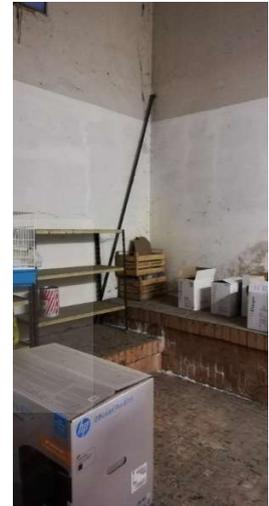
Locale taverna a piano interrato / Foto 17 – Locale deposito nella taverna
